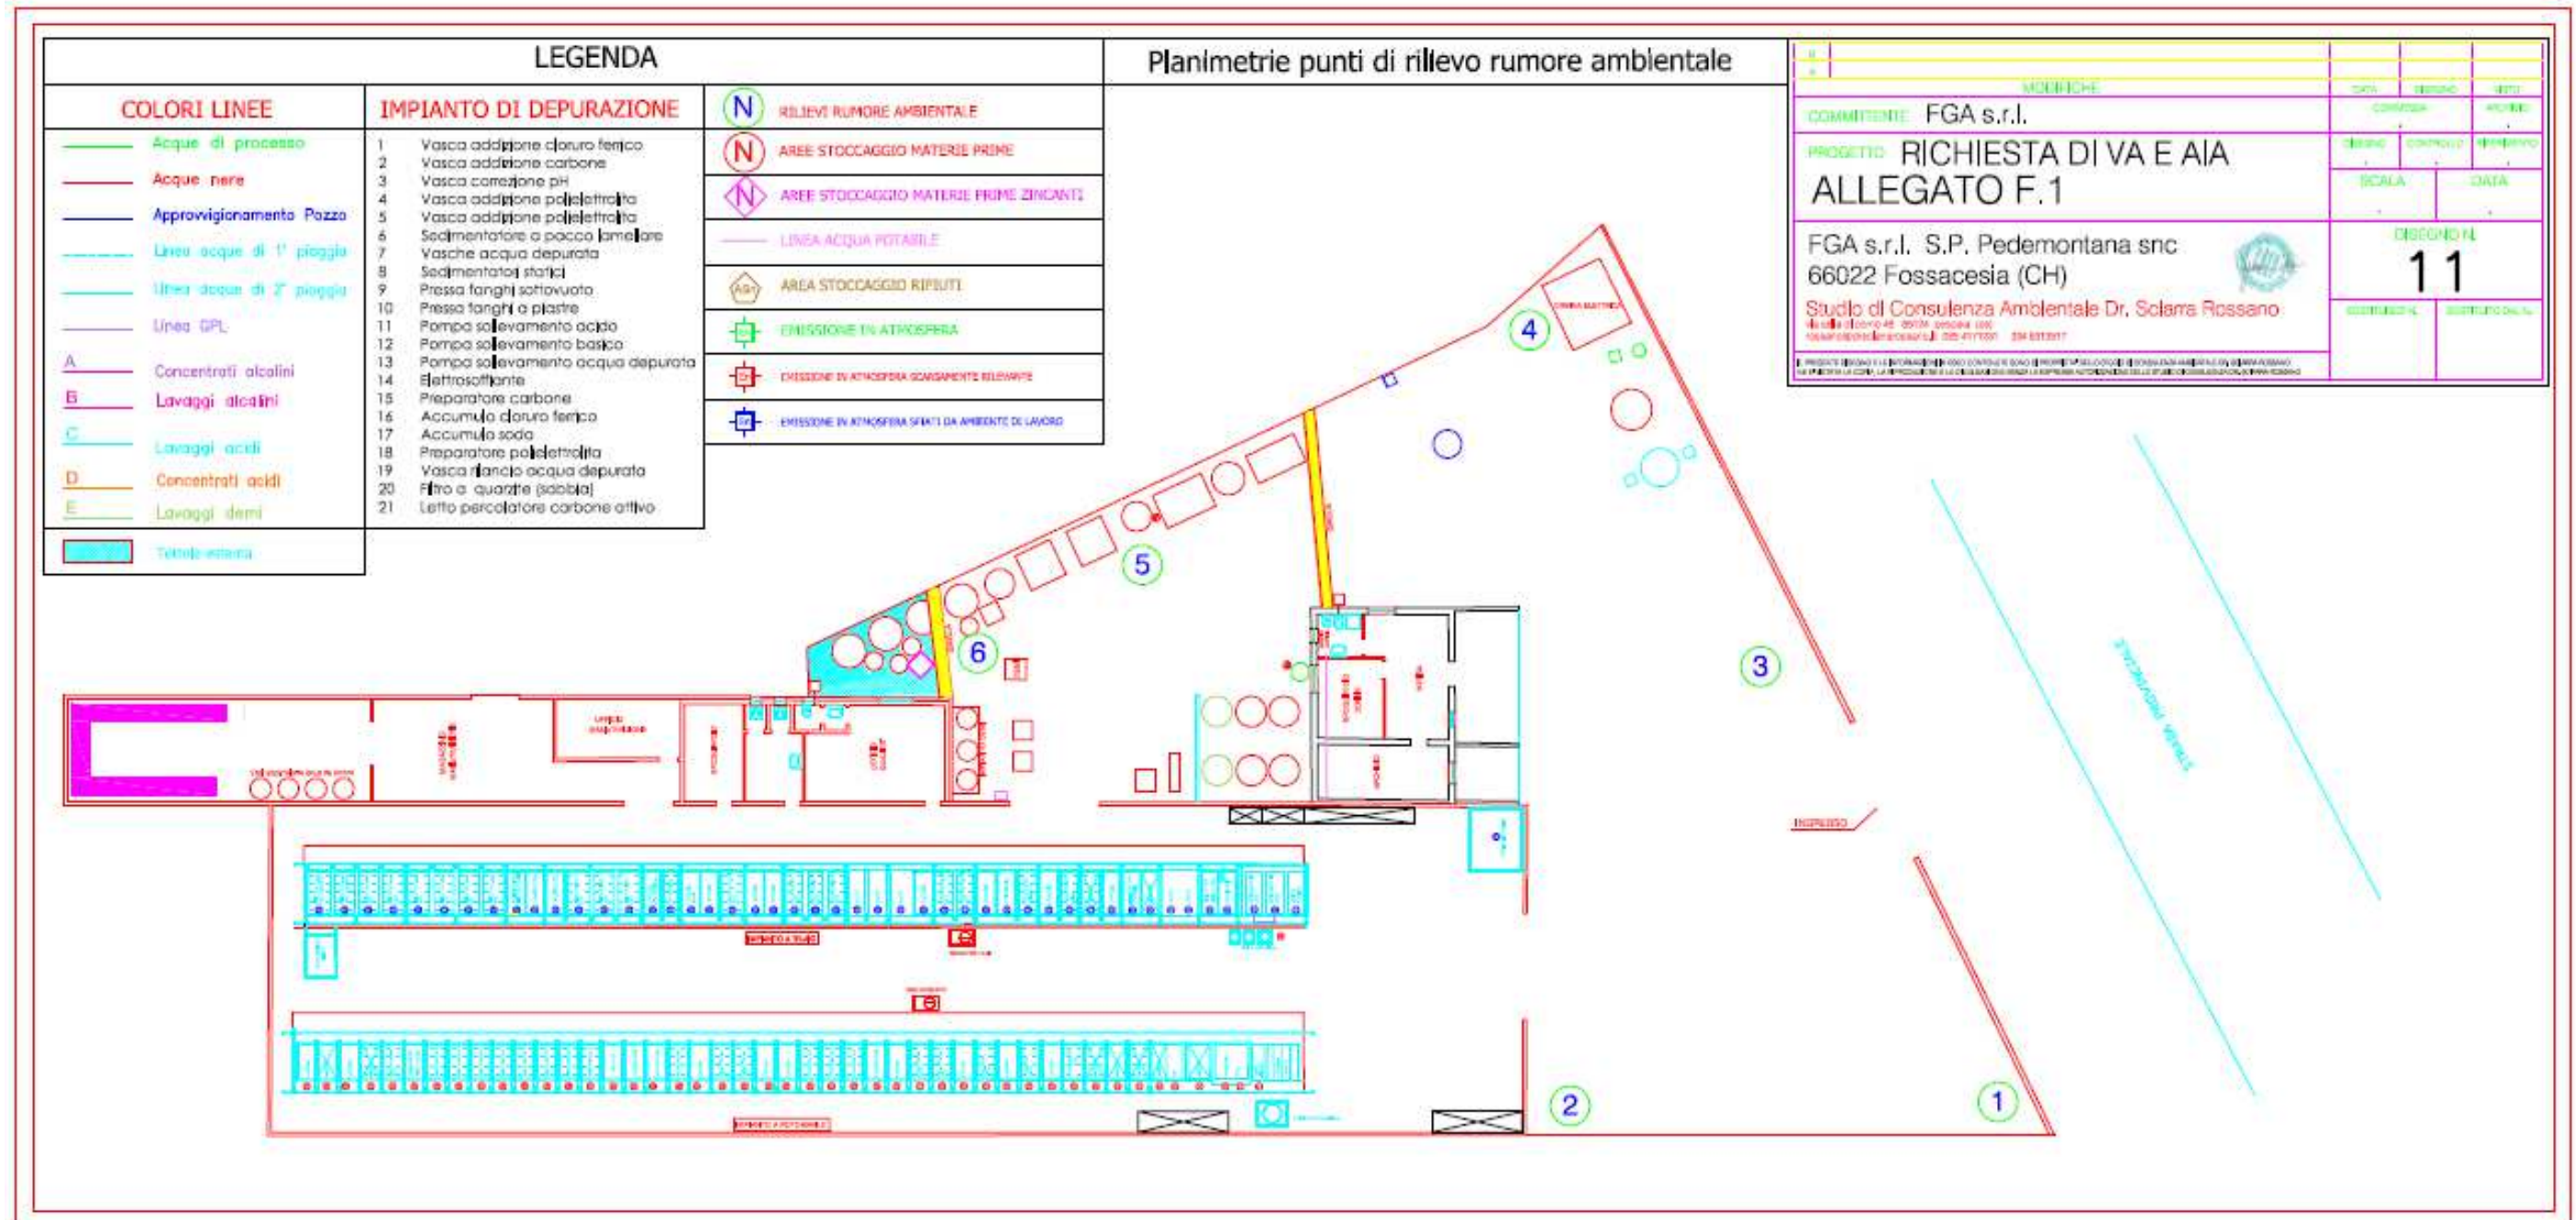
Planimetria con indicazione dei punti di Rilievo
